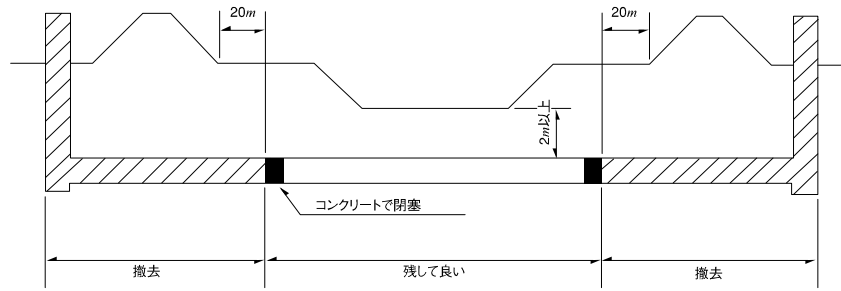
撤去に伴う護岸の施工範囲 (高水護岸がない場合)
